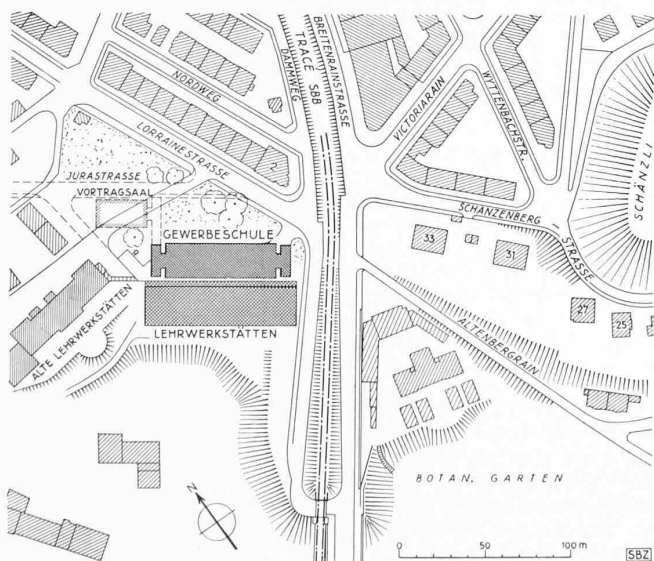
Lageplan 1:4000 der Gewerbeschule und Lehrwerkstätten
